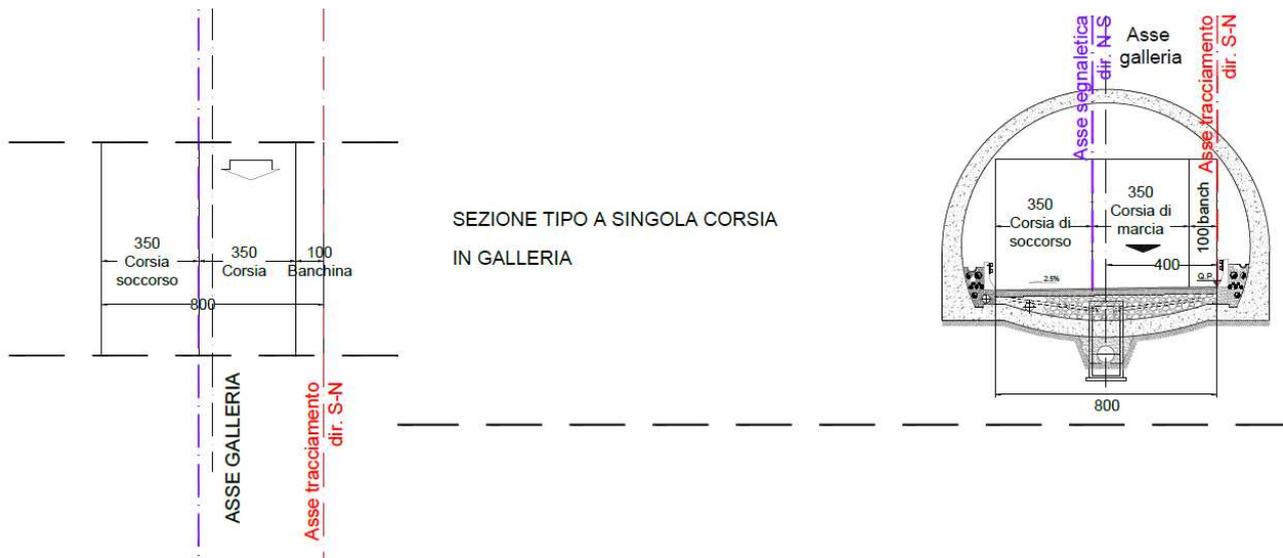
Schema planimetrico e sezione stradale per i tratti in galleria
